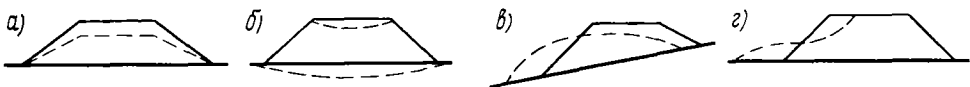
Характерные деформации и разрушения земляного полотна: а – осадка; б – просадка; в – сползание насыпи; г – то же откоса
